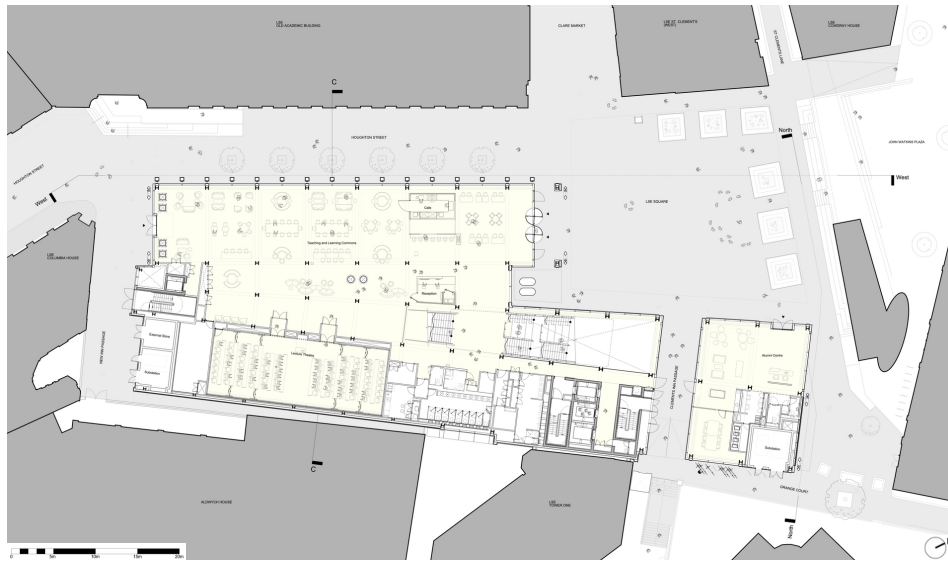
LSE Centre Building | Planta do 1  Pavimento
